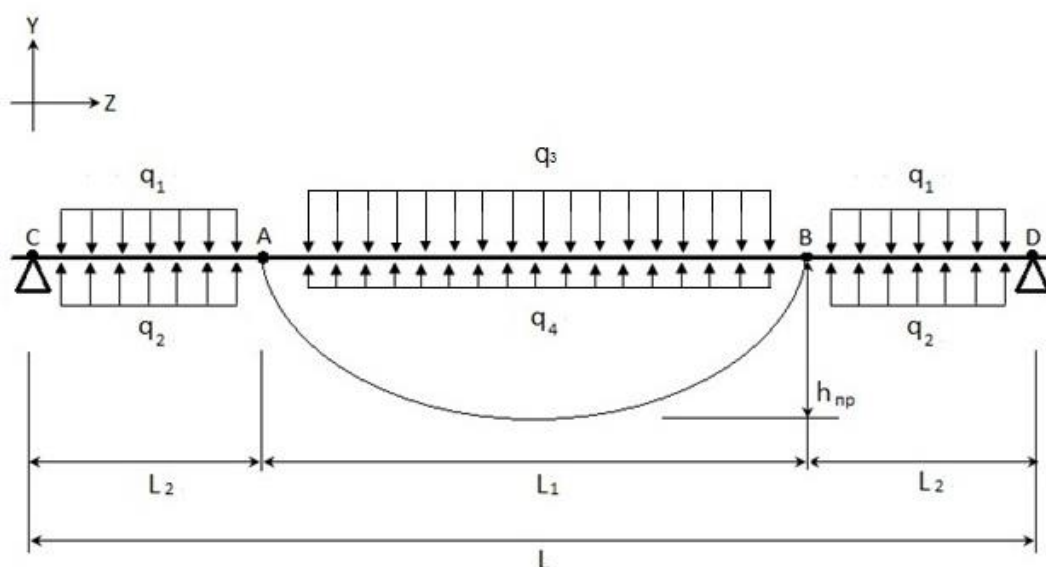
Расчетная схема участка нефтепровода в зоне осадки грунта
